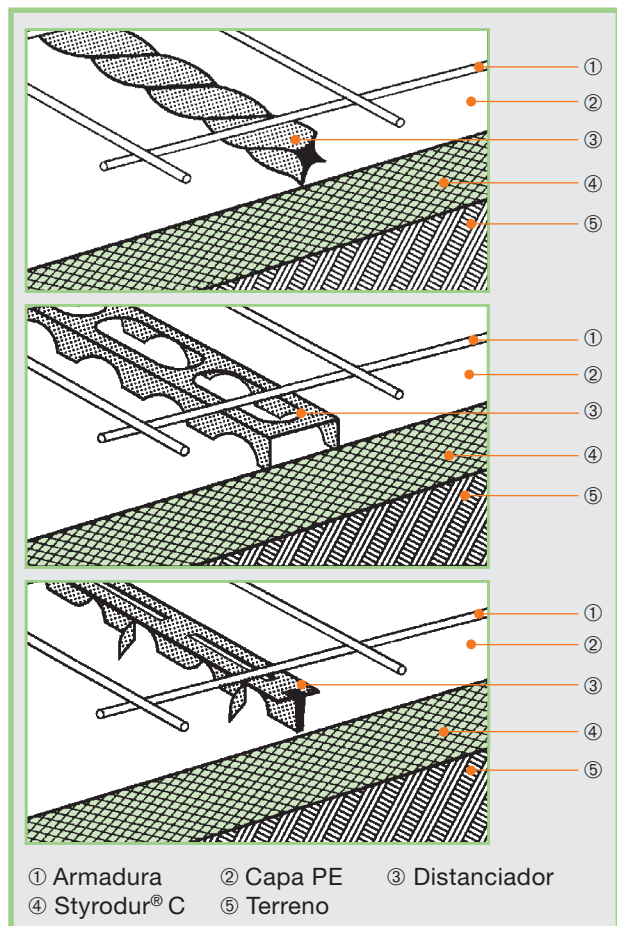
Distanciador de plástico para la armadura horizontal. La altura del perfil determina la altura de la cubierta superior de hormigón.
